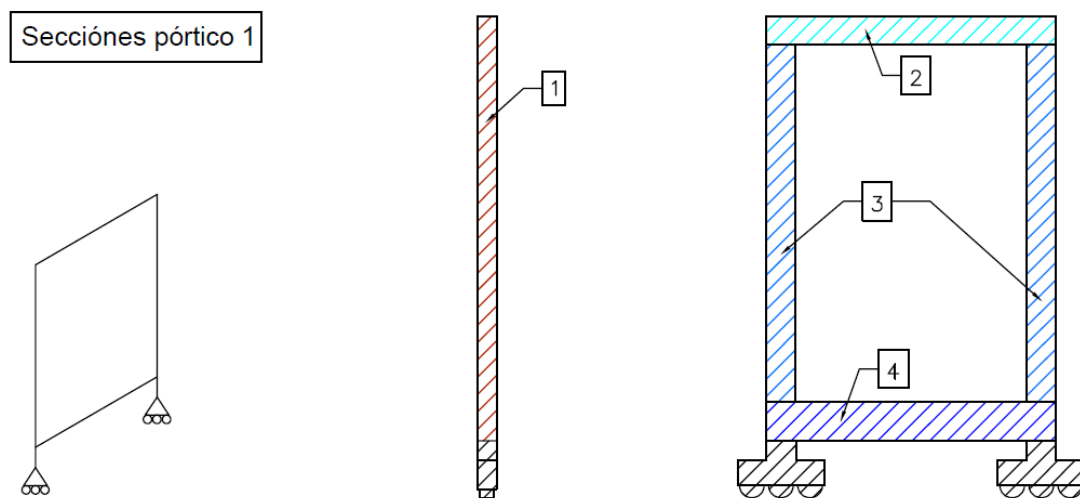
Secciones numeradas para aplicación del viento. Pórtico 1.
